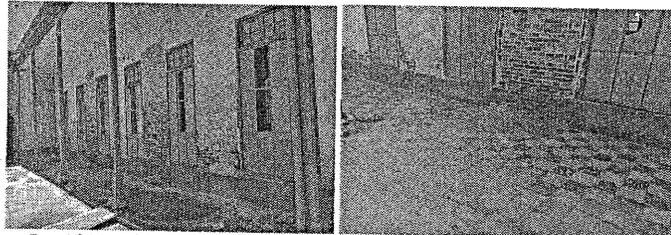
y N° 11.- Muros laterales, columnas de madera y piso de loseta deteriorados
